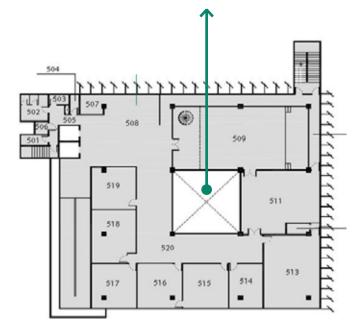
Planta Térreo do Prédio de vidros. Fonte: levantamento realizado pela consultora.
